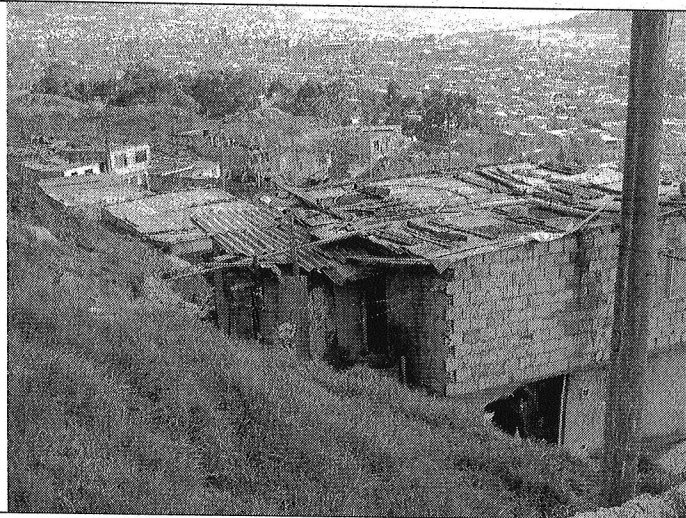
Vista General del lote 2 manzana 13 y Zona Verde 5 (Observar Figura 1)
